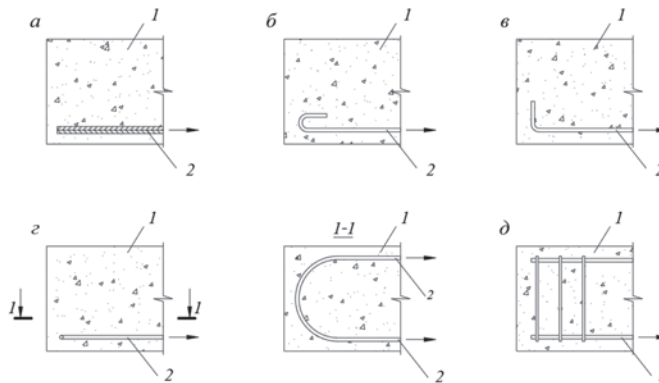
Анкеровка рабочей арматуры в бетоне элемента: а – сцеплением прямых стержней с бетоном; б – крюками; в – лапками; г – петлями; д – приваркой поперечных стержней; 1 – бетон; 2 – анкеруемый стержень
